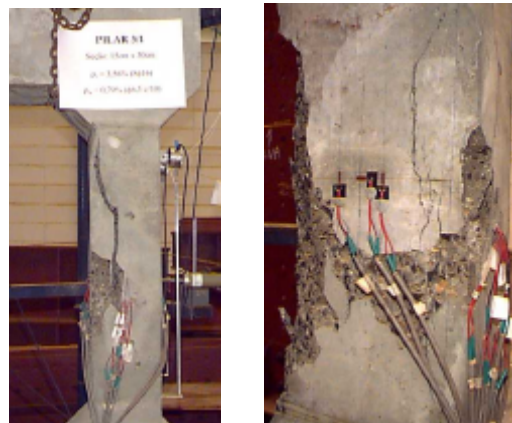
Forma de ruptura do pilar P3/1
